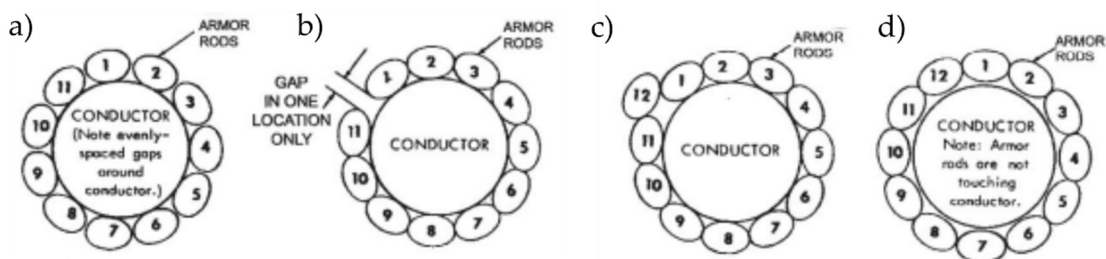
Exemplos de aplicação de emendas. (a) Instalação preferível com folgas igualmente espaçadas entre as varetas. (b) Varetas instaladas com folga em apenas um local do conjunto. (c) Emenda com encavalamento de uma das varetas devido ao número excessivo de varetas. (d) Montagem com contato lateral entre todas as varetas impossibilitando o agarramento das varetas ao cabo. [2]
